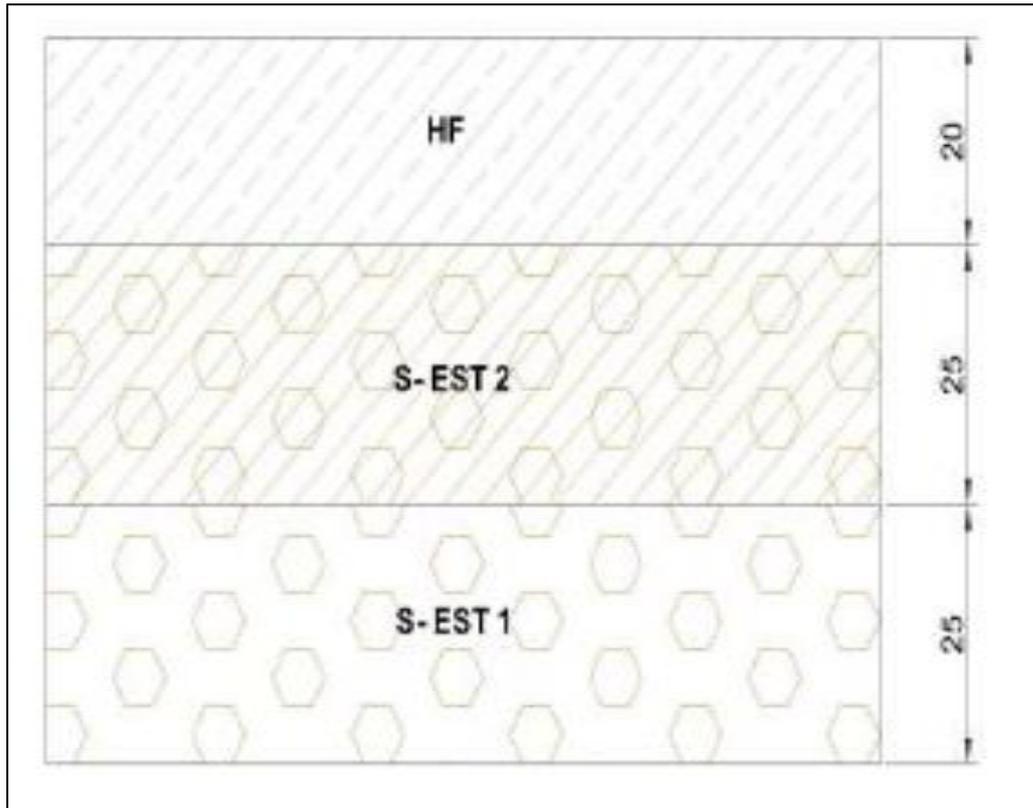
Sección del firme. Fuente: Proyecto de planta de tratamiento de Residuos de construcción y Demolición en Algemesí (Valencia).
